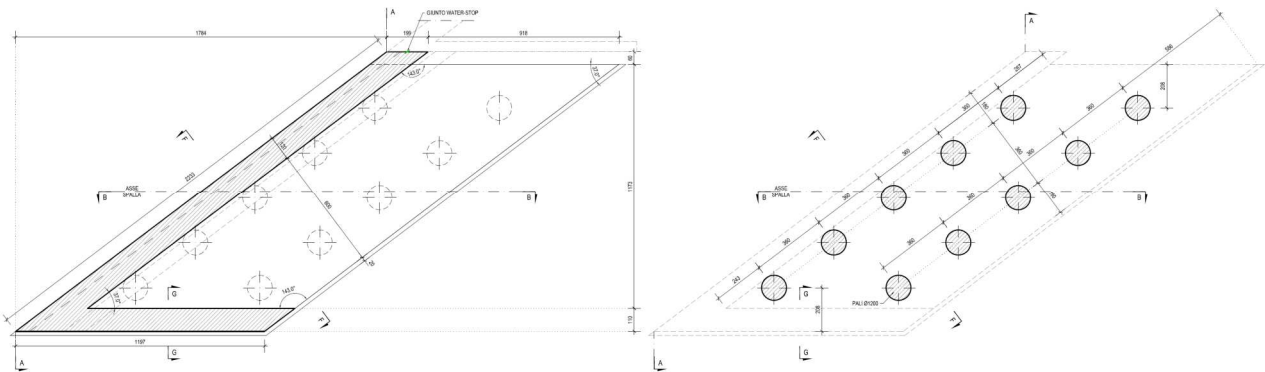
Sezione di carpenteria_Spalla 2
